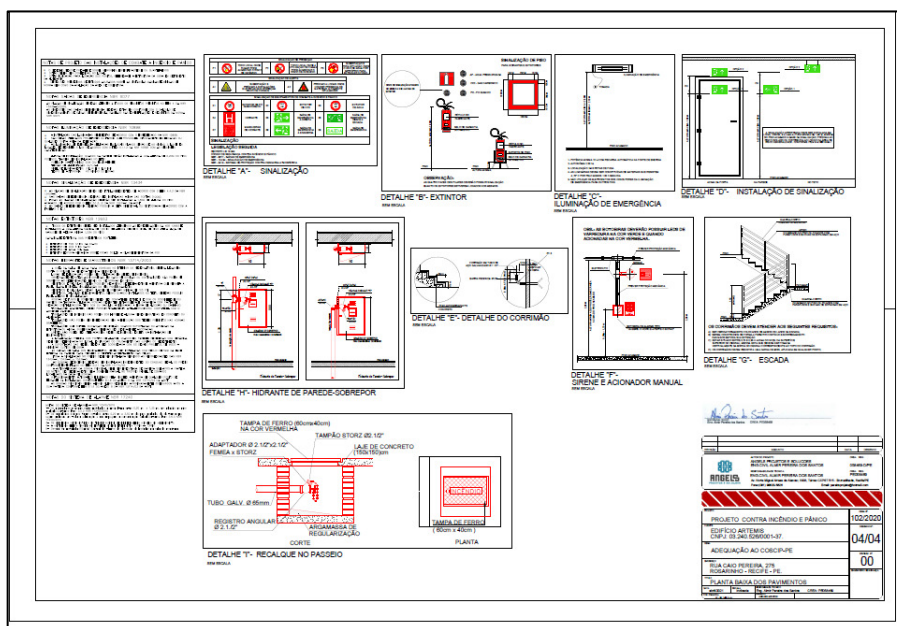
AutoCad – Projeto de combate a incêndio (planta baixa, isometria, 3D, informativos)
